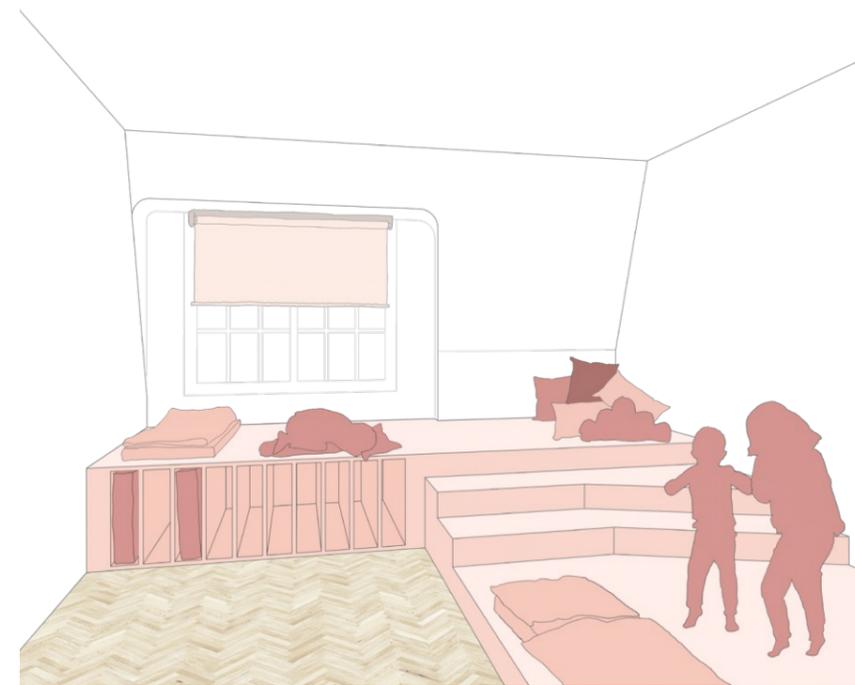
Darstellung Ruheraum, Raum 07, Dachgeschoss.
